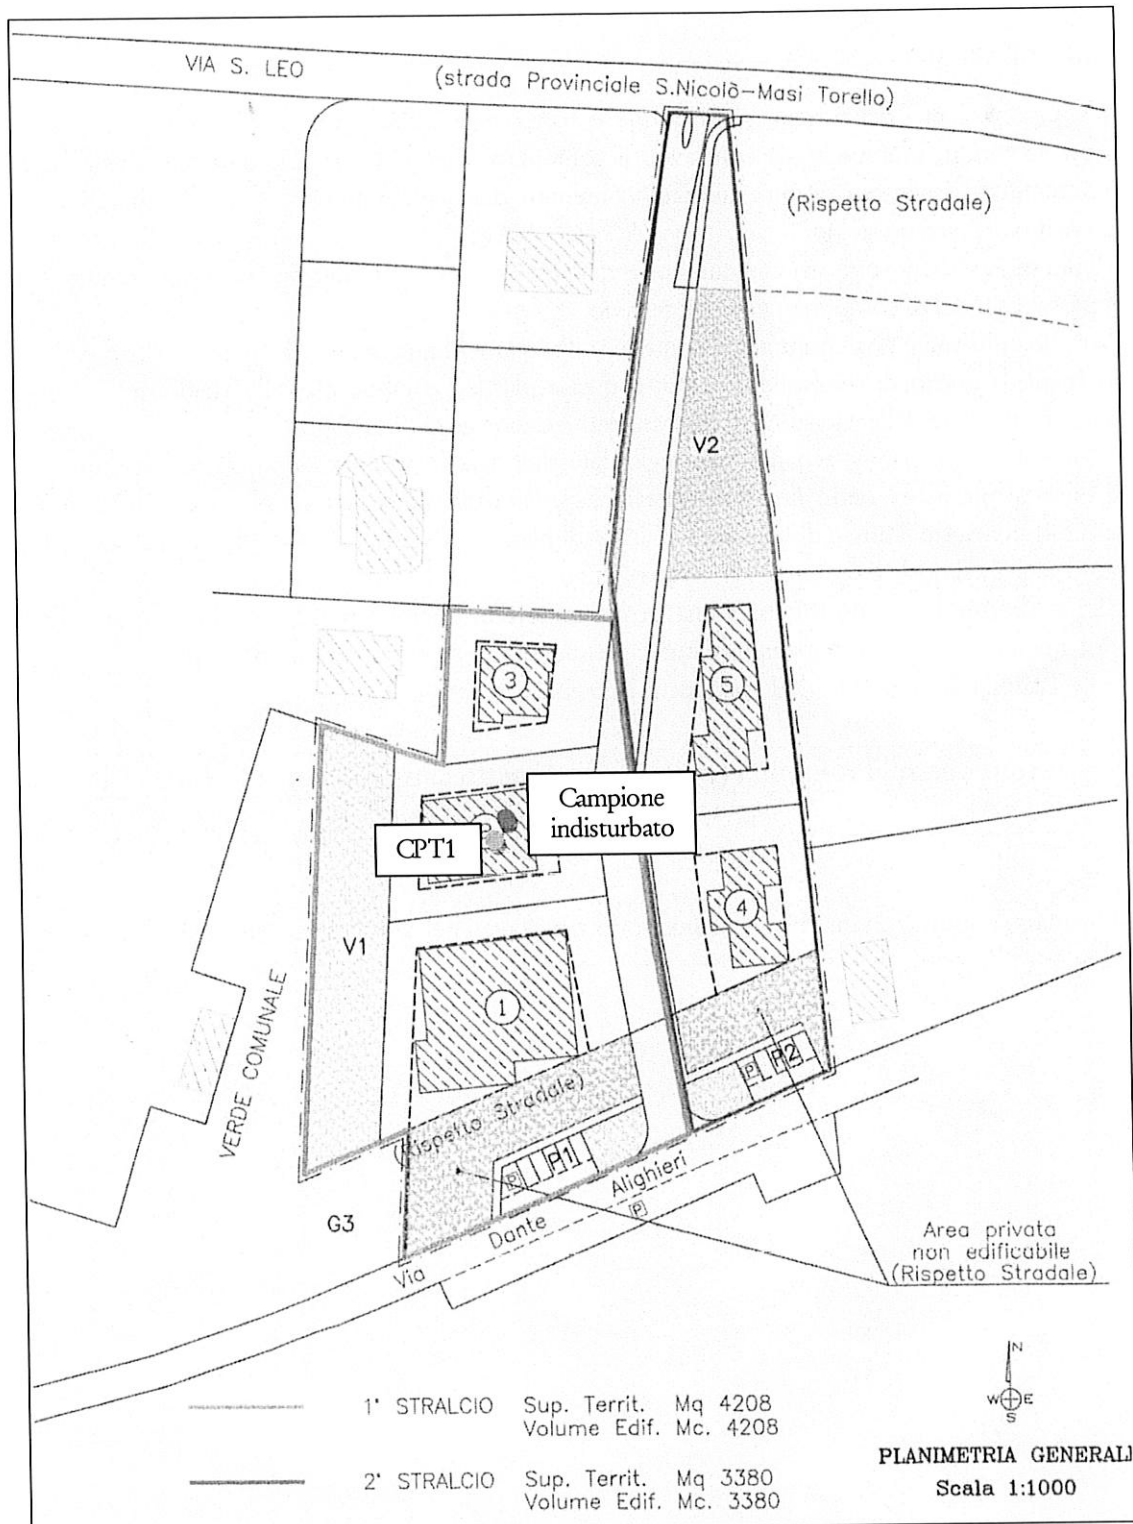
Planimetria generale con ubicazione prou e prelievo campione indisturbato
